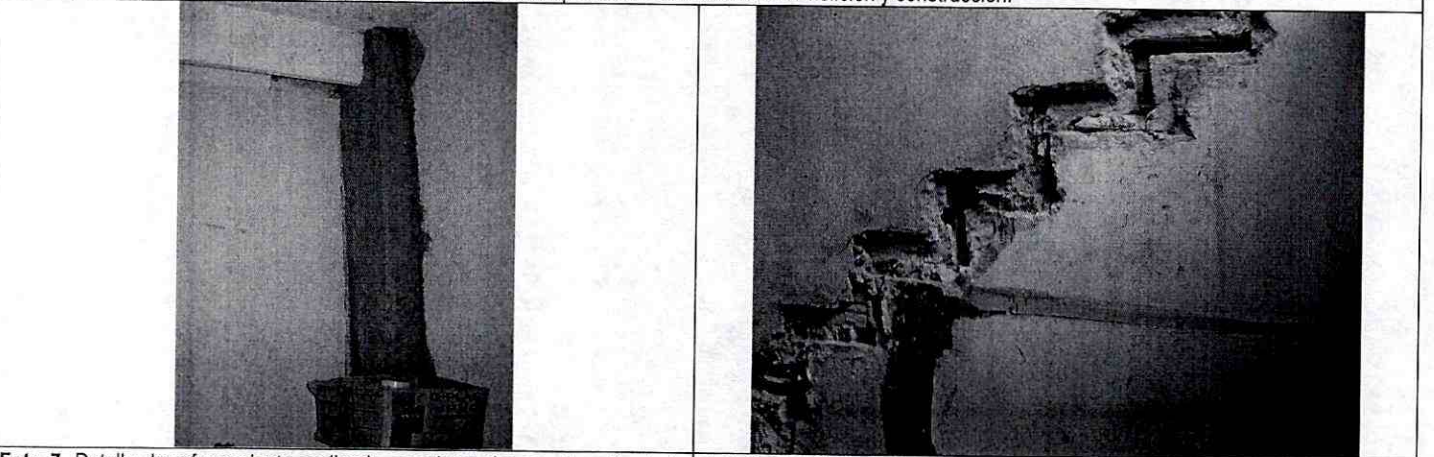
Detalle de reforzamiento realizado en primer piso en el predio de la Transversal 52B # 1-69
